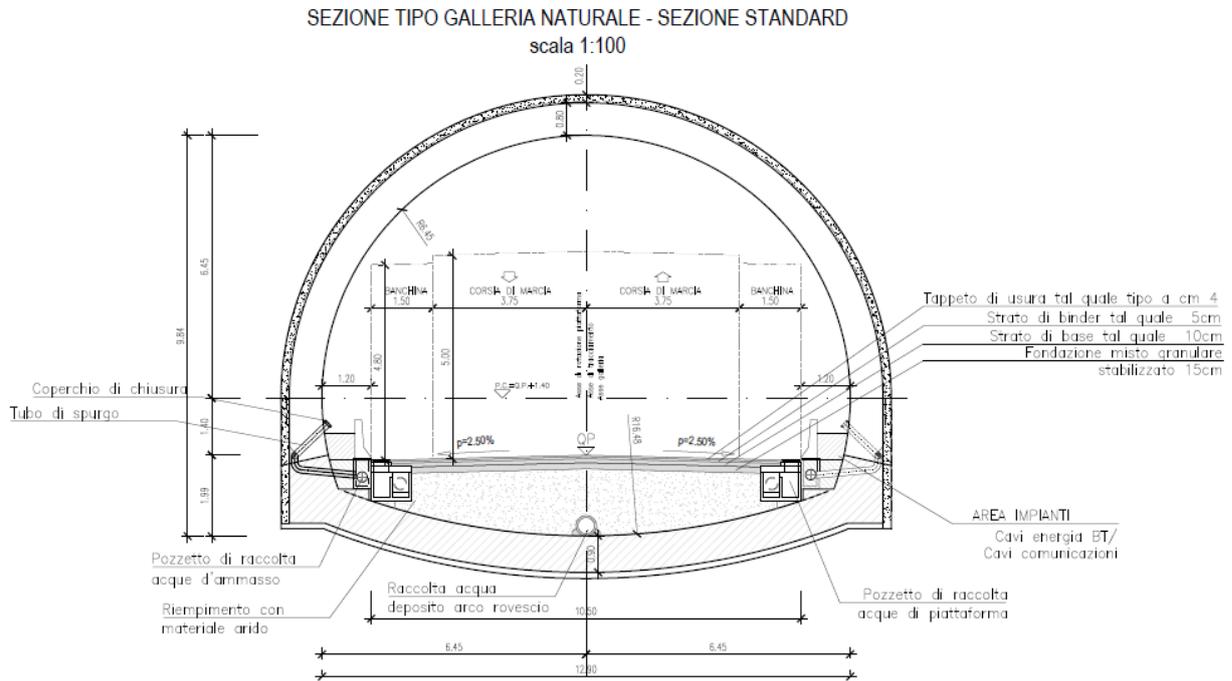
Sezione tipo idraulica di piattaforma in galleria.
